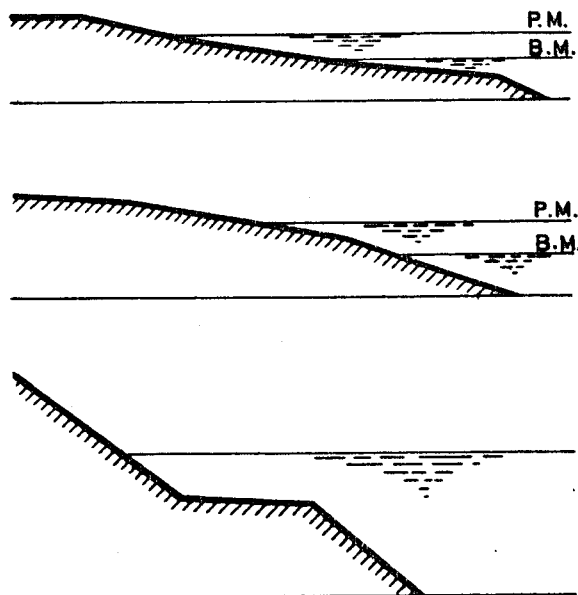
Configurações de Estruturas com Paramento Exterior não Plano
